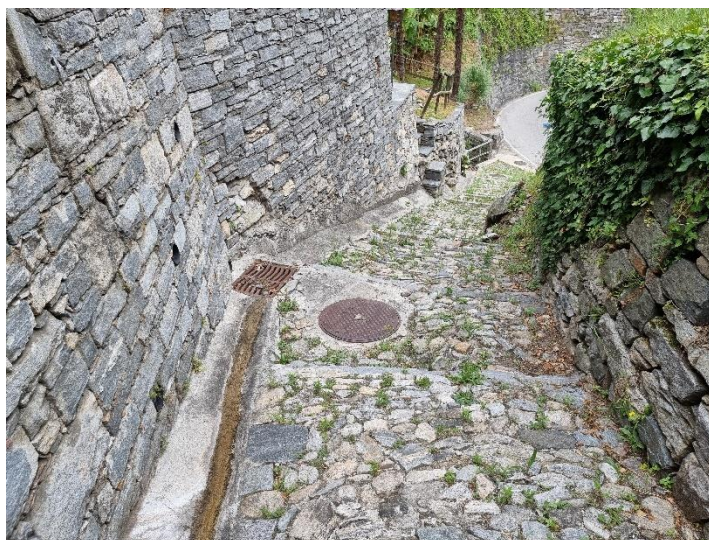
situazione pavimentazione scalinata vicolo Zucca
